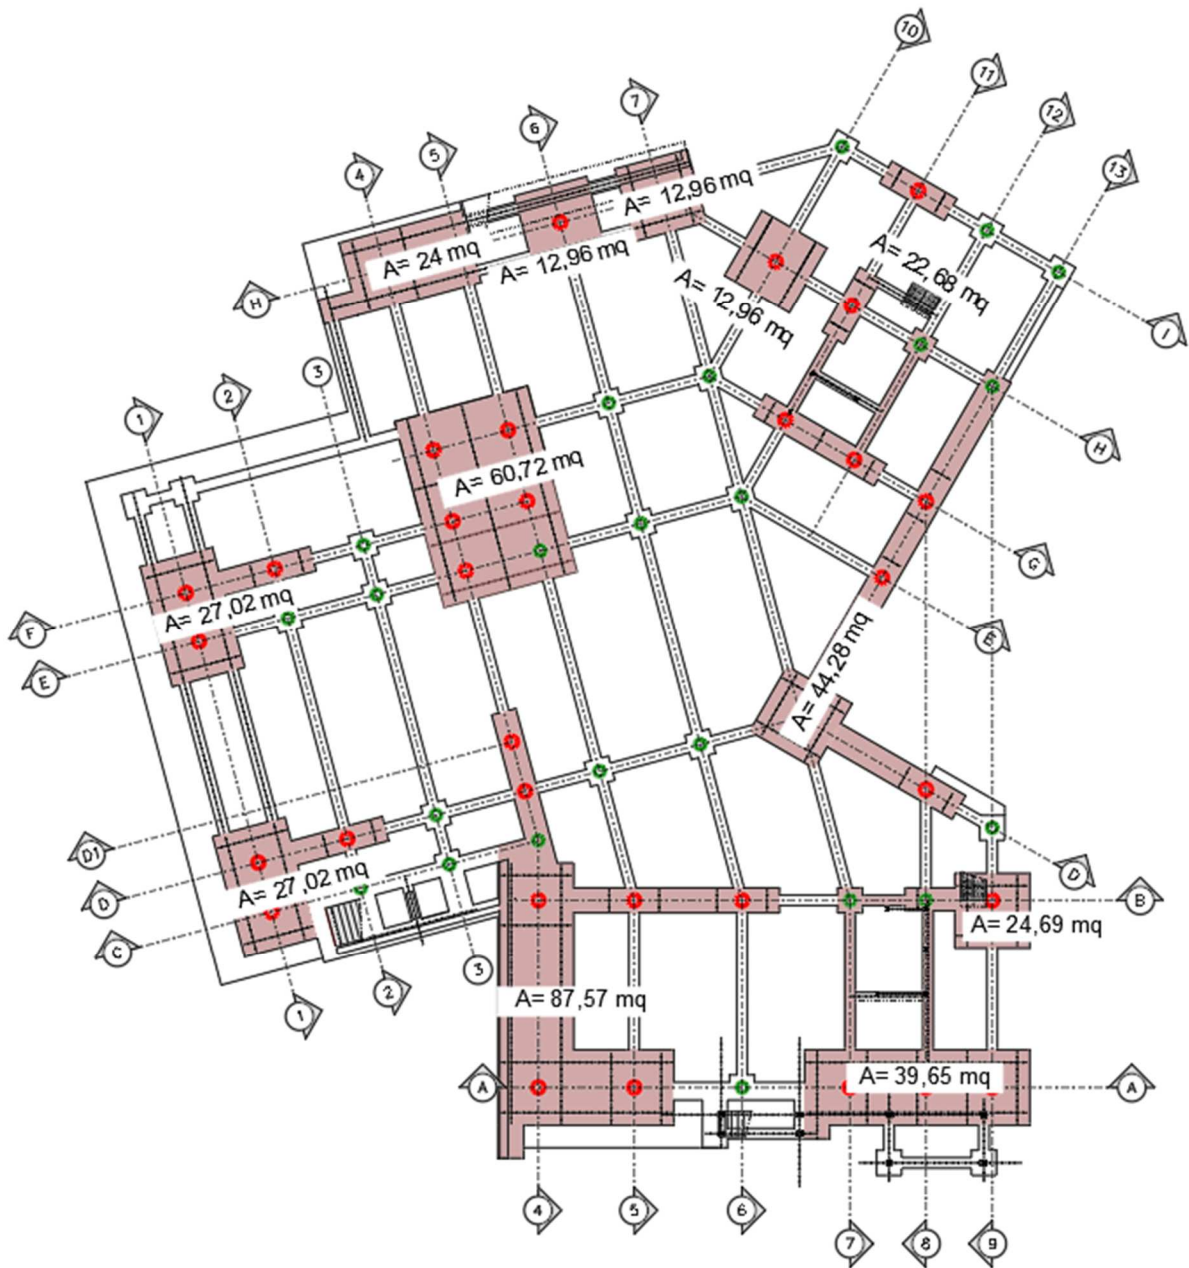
Piano fondazione: area cordoli e plinti con H=150 cm (campitura color mattone)
